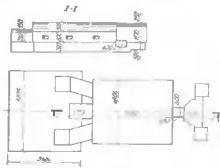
Ванный печь с подковообразным направлением пламени и загрузочным карманом, расположенным с торца печи между горелками
